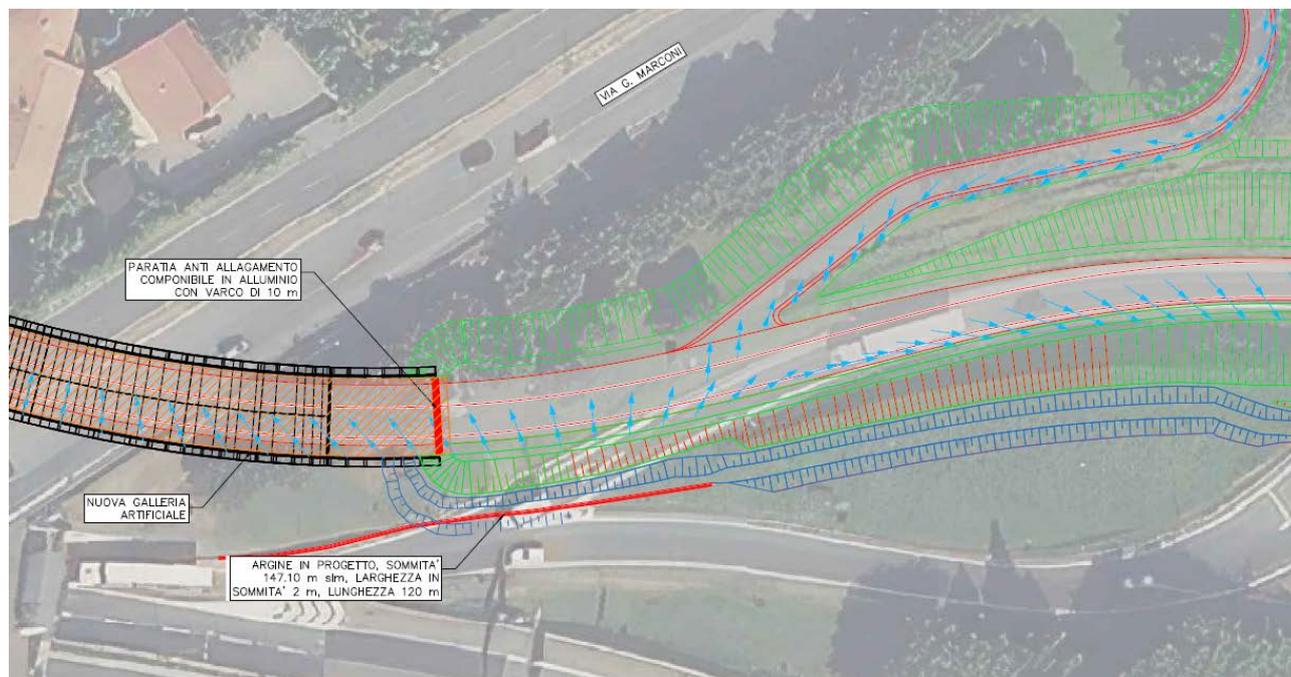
Planimetria delle opere previste per contrastare le esondazioni da parte del fiume Lambro.
